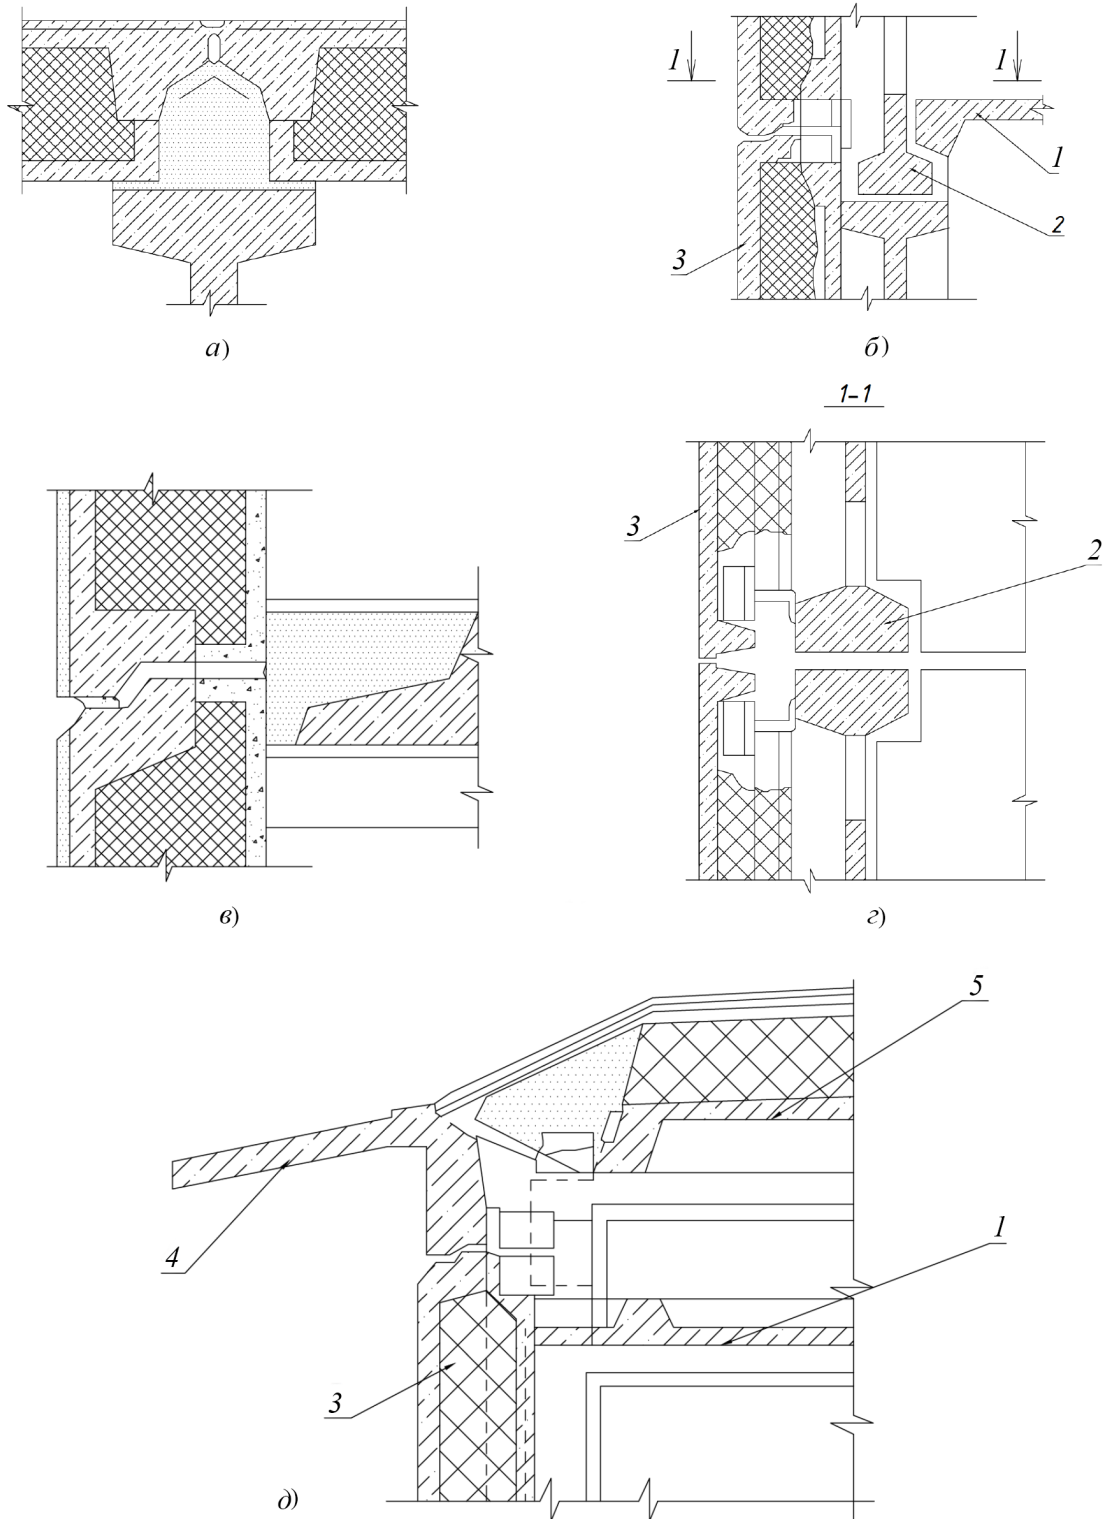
Стыки: а – вертикальный стык наружных стеновых панелей; б – горизонтальный стык наружных стеновых панелей; в, г – крепление торцевых наружных стеновых панелей к железобетонным несущим панелям (поперечный разрез 1-1); д – крепление карнизного блока;
